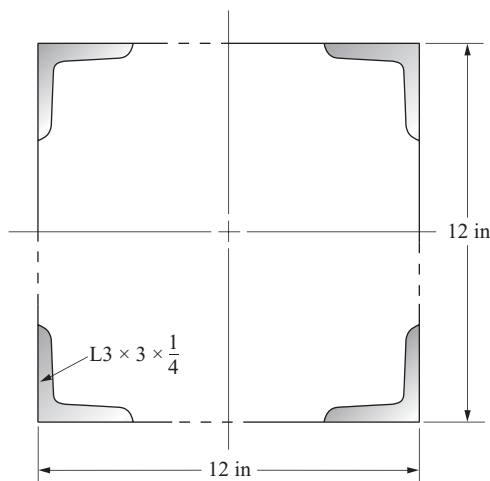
Sección de columna compuesta del Problema de ejemplo 11-13.
